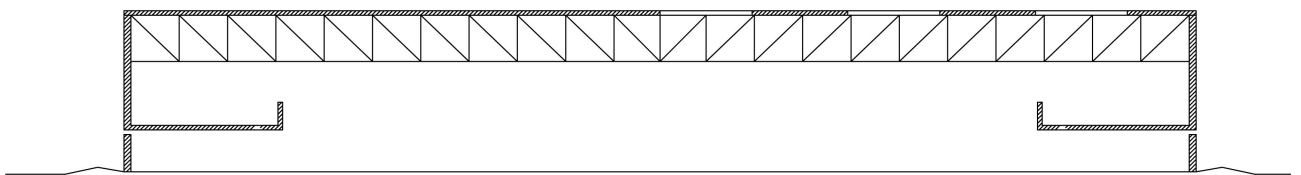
Propuesta de sección con cercha separada 13,5 metros bi-apoyada en pilares empotrados.
